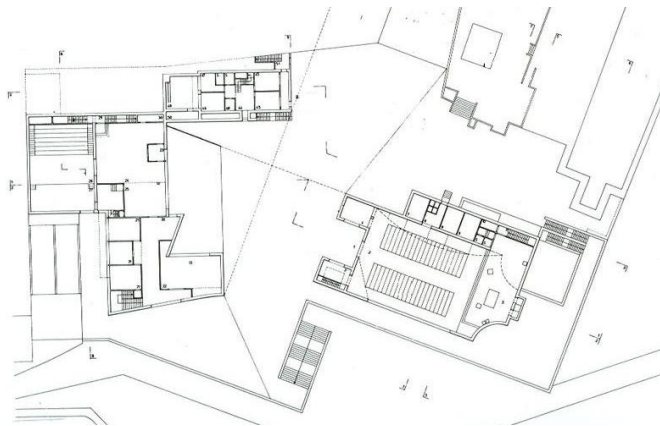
| Igreja Marco de Canaveses - Planta | ArchDaily
